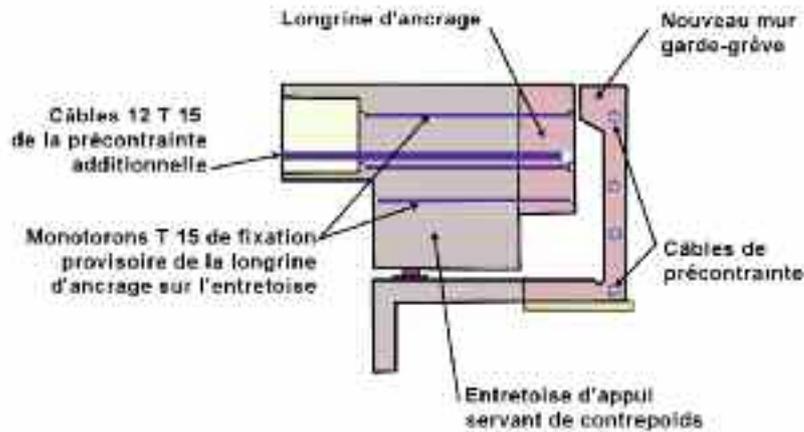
détail du renfort de l'entretoise sur culée pour l'ancrage de la précontrainte additionnelle
